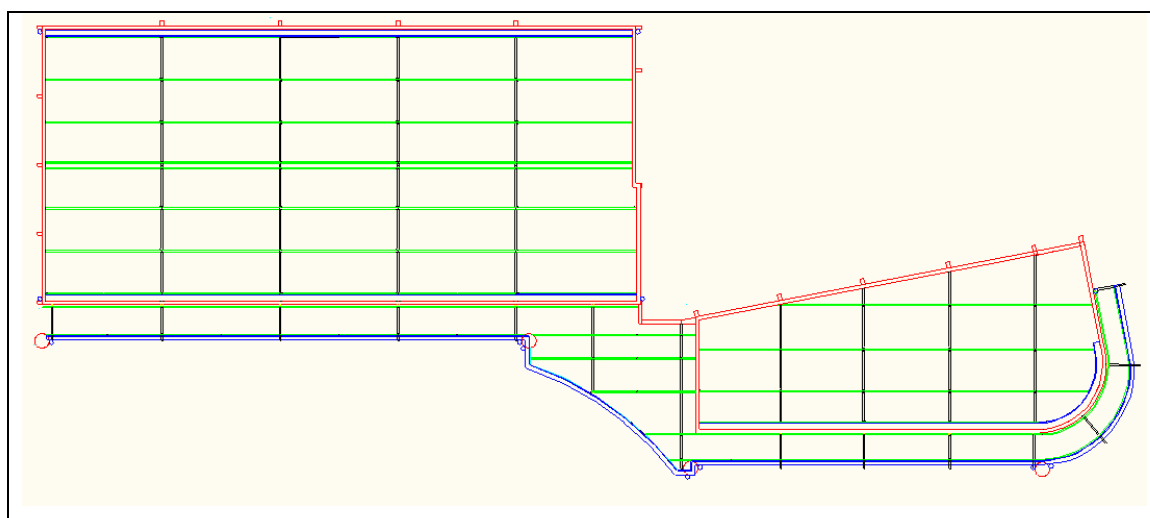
Configuração prévia da cobertura (melhor visualizado na planta de sistemas XX)
